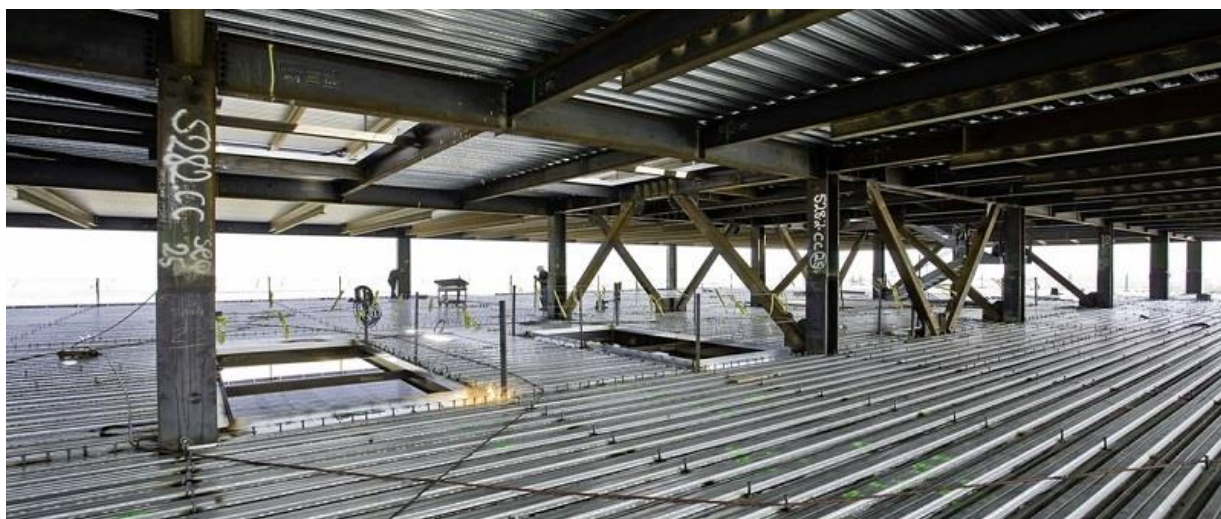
Применение перекрытия с использованием стального профилированного настила в качестве внешнего армирования в здании со стальным каркасом
